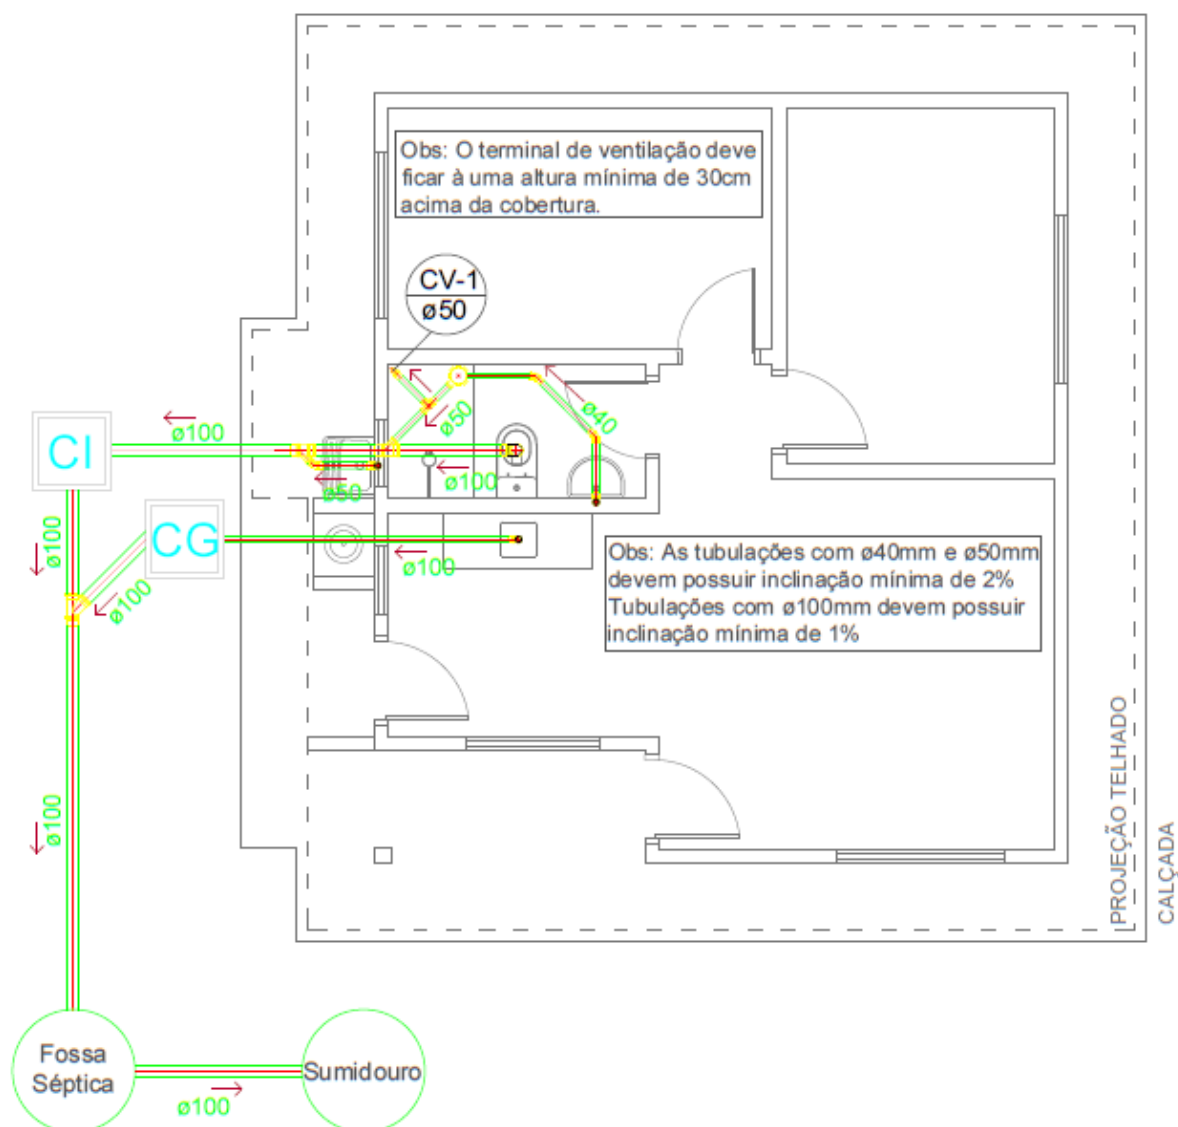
Planta Baixa do Pavimento térreo, Detalhamento da Rede de Esgoto
